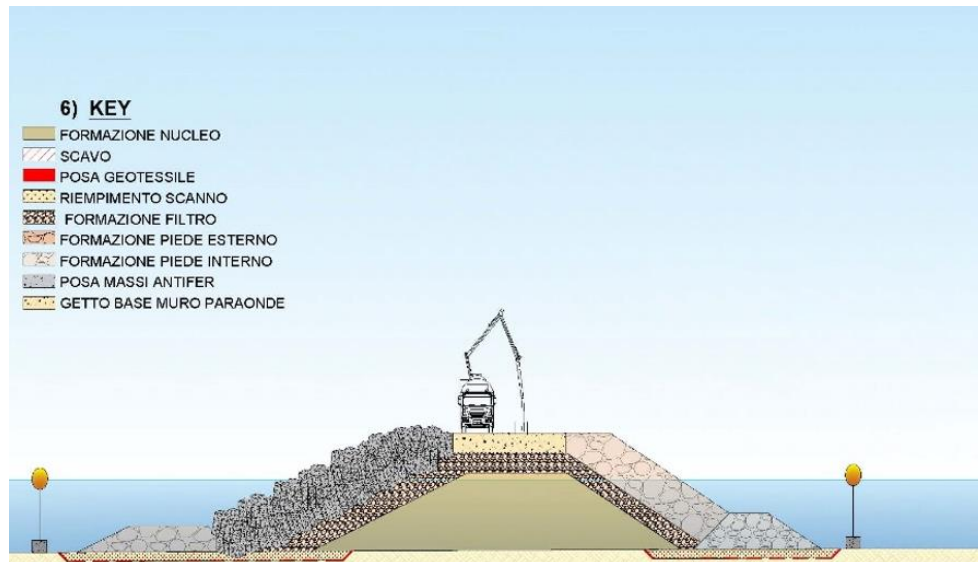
Fase 6: realizzazione fondazione muro paraonde
